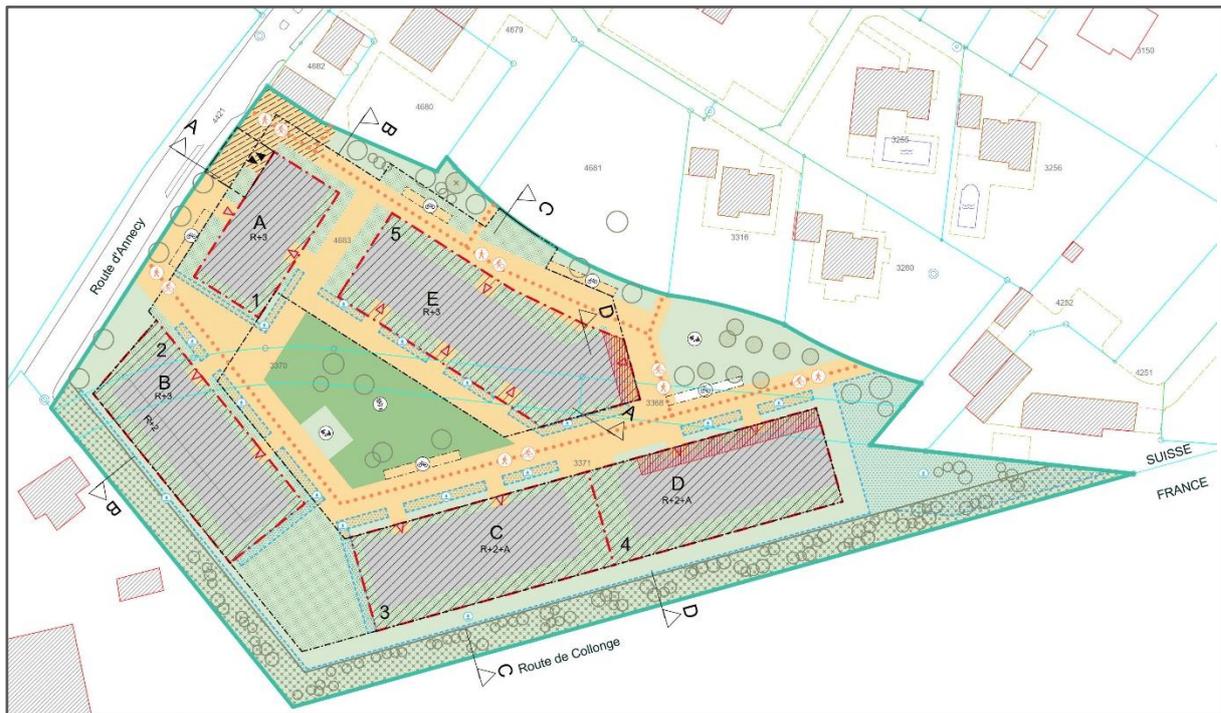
Situation générale du PLQ « La Mure » et implantation des bâtiments
